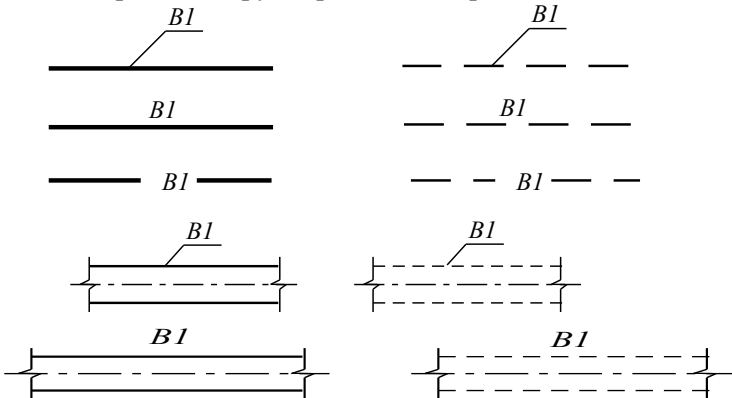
Приклад зображення трубопроводів на кресленнях та схемах
